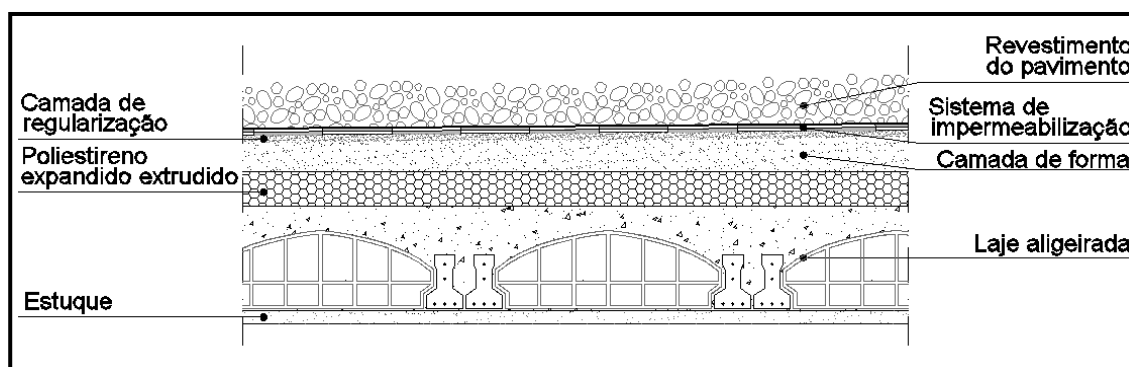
Pormenor da cobertura horizontal não acessível, em corte (COB03)
